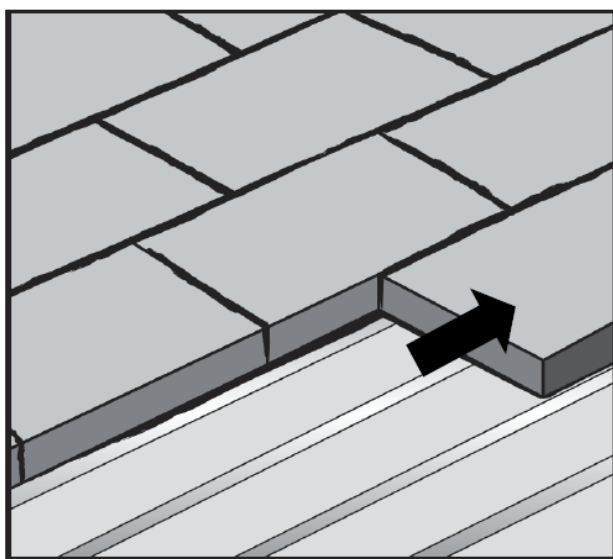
Pose de la plaque isolante sur tôle d'acier nervurée
